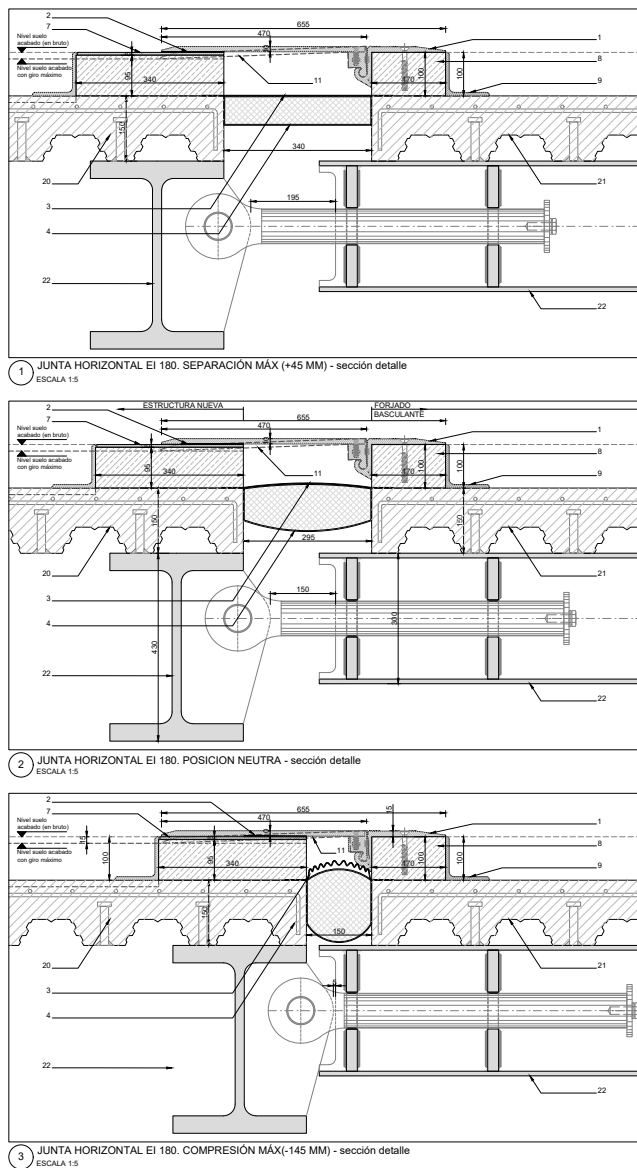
Secciones detalle del encuentro entre forjado de museo (derecha) y forjado basculantes (izquierda) mostrados en situación de máxima apertura, posición neutra y máxima compresión. Detalles procedentes del proyecto de ejecución.
